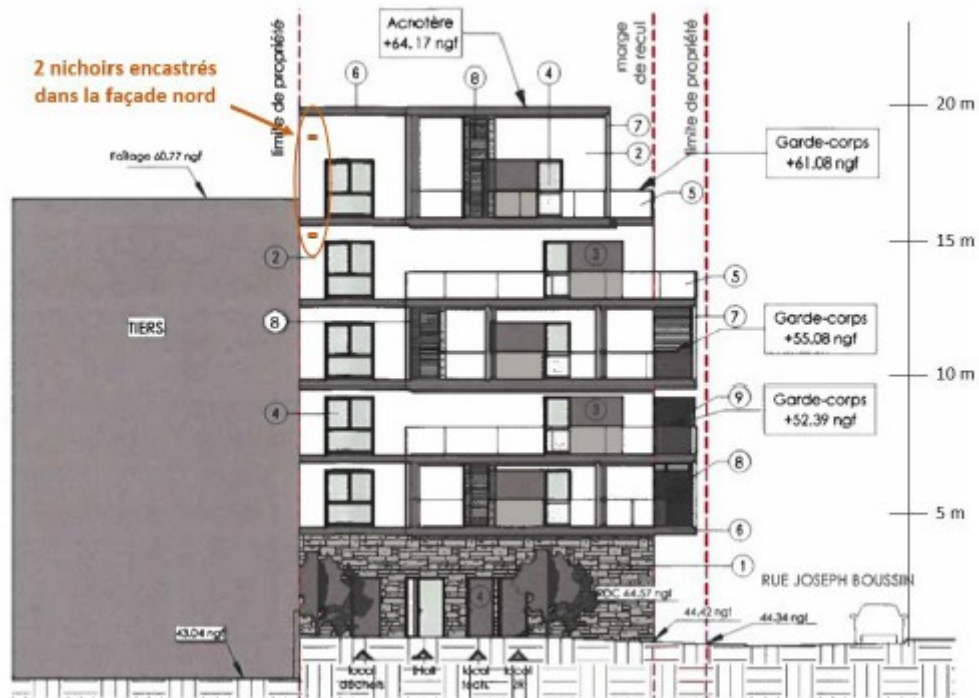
Proposition d'installation de nichoirs sur les façades est et nord du 19 bd Jean Mermoz
